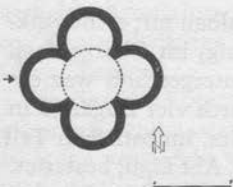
Avolsheim, St. Ulrich, nach 996, Grundrißrekonstruktion nach R. Kautzsch 1944, M. 1:500.
